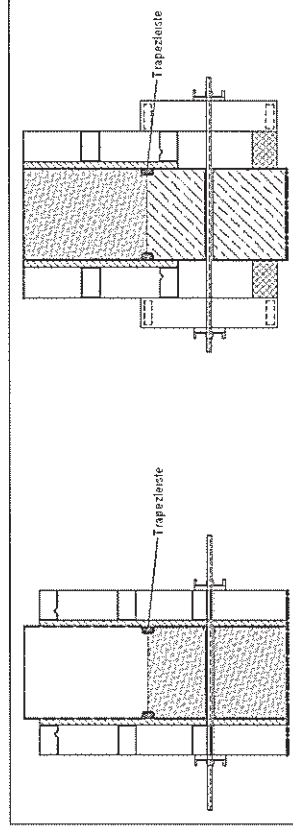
Arbeitsfuge mit Trapezleiste; links: erster Betonierabschnitt; rechts: zweiter Betonierabschnitt
